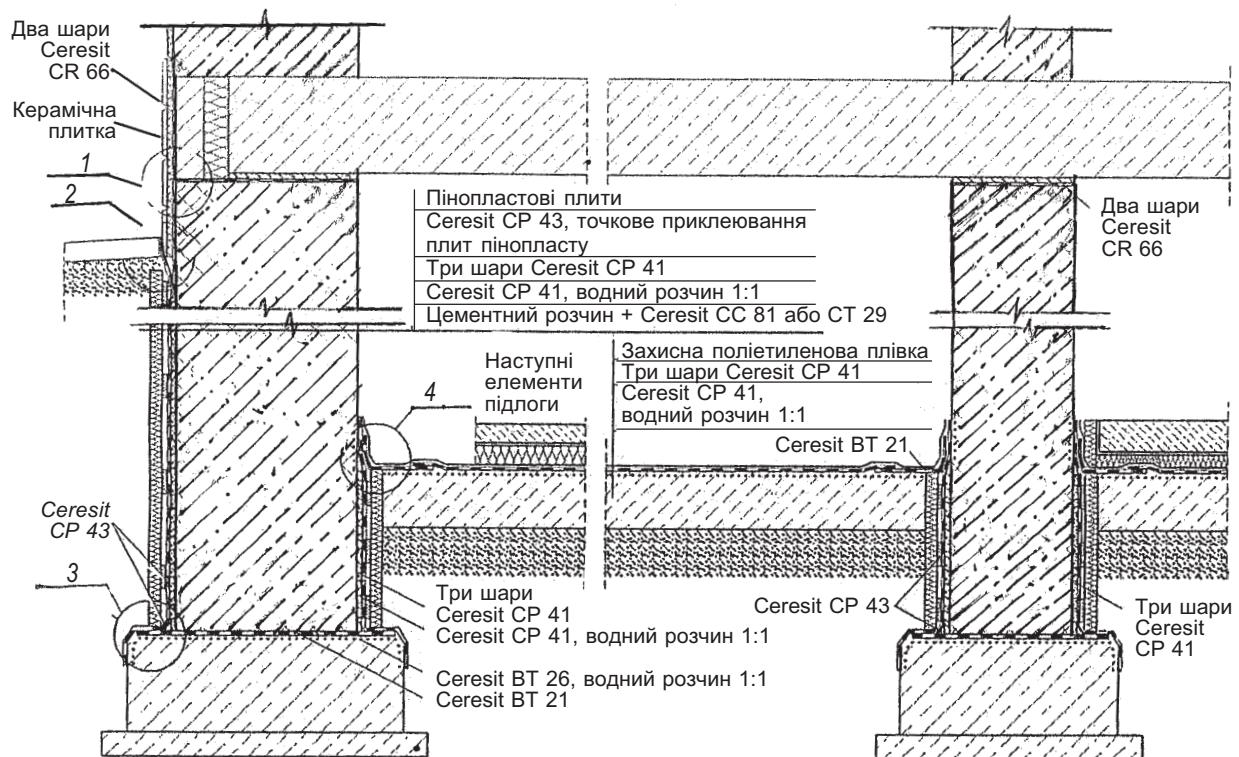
Гідроізоляція фундаменту та стін підвалью від ґрунтової вологої
